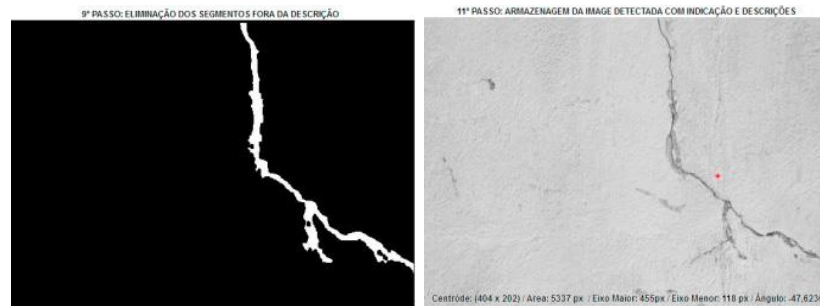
Detección de grietas sobre concreto (Pereira & Pereira, 2015)
